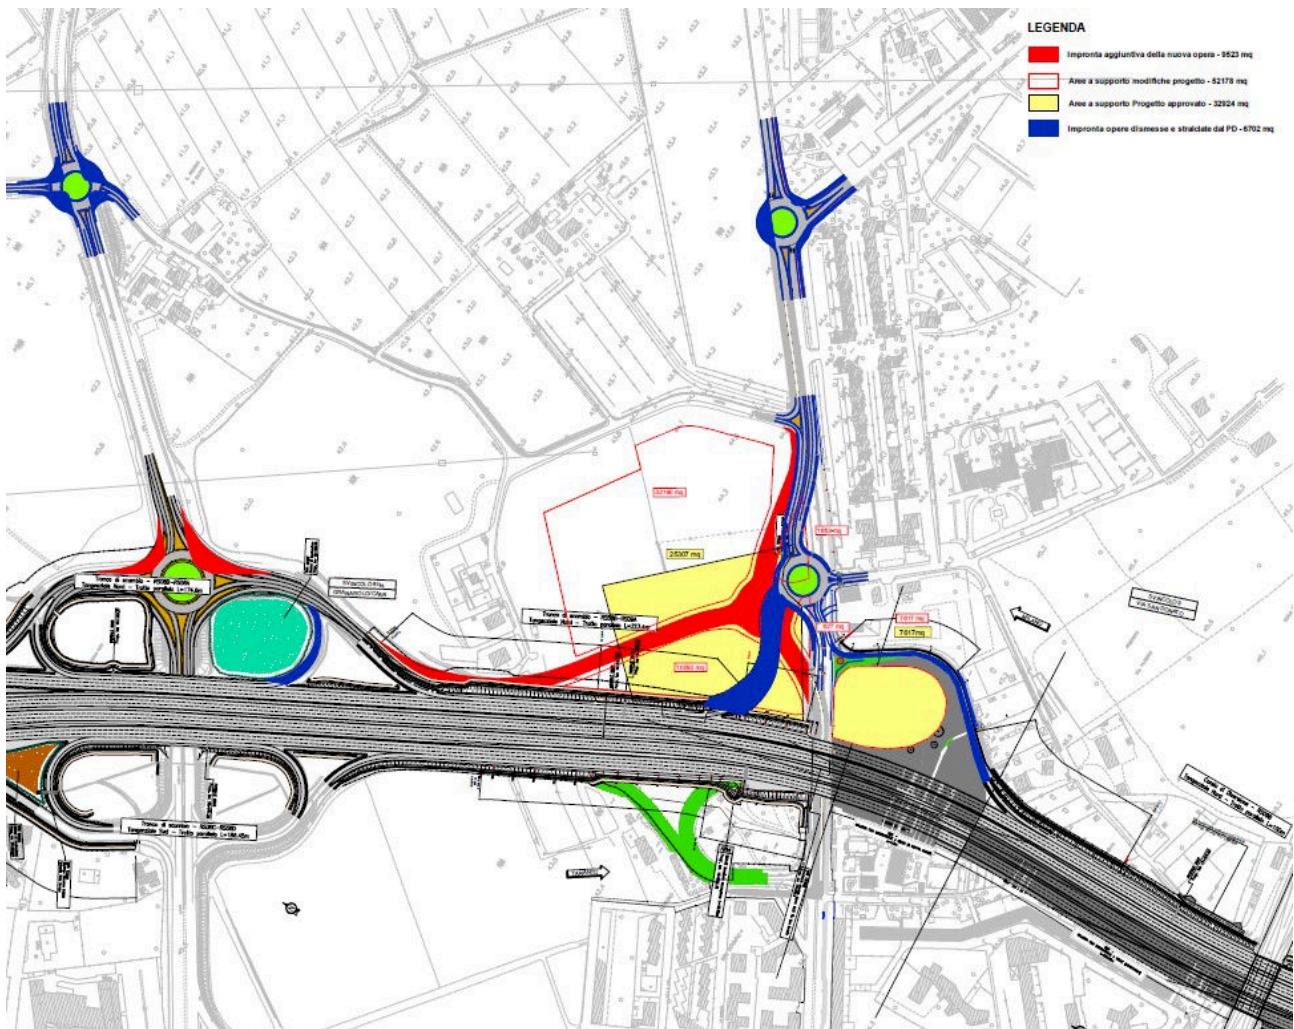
Planimetria occupazione di suolo definitivo e aree temporanee a supporto dei lavori: raffronto tra progetto approvato e progetto di chiusura progetto di chiusura totale e realizzazione nuova bretella (Fonte: Tavola 4)
